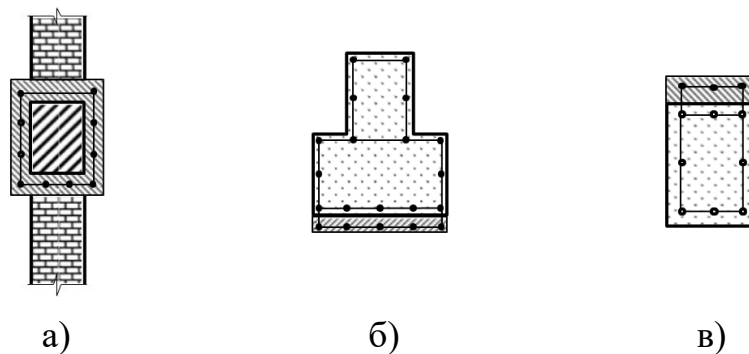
Підсилення залізобетонних балок методами збільшення перетину: а) встановлення обойми; б) нарощуванням перетину в розтягнутій зоні; в) нарощуванням перетину у стиснутій зоні
